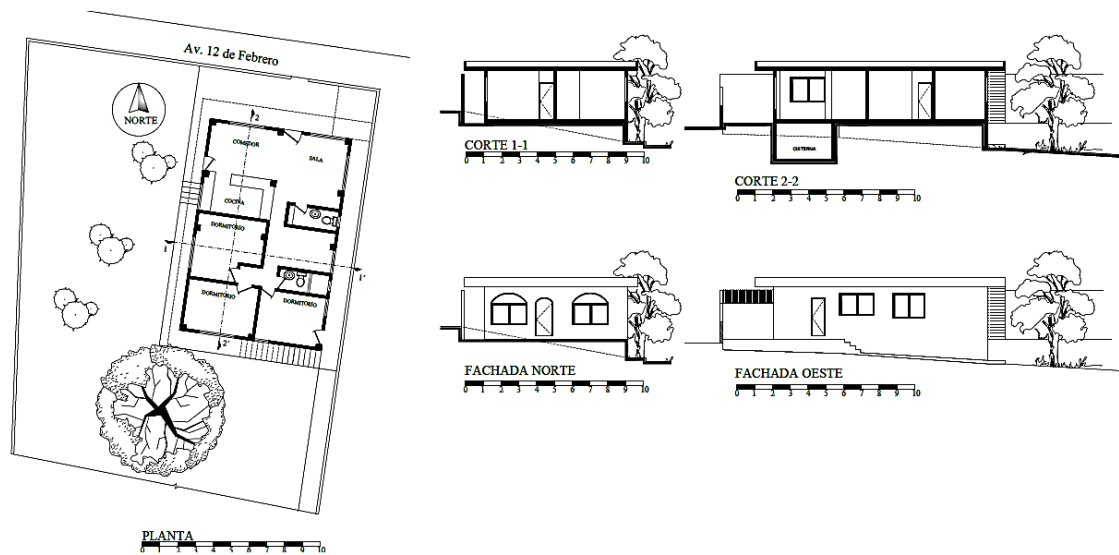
Plantas, cortes y fachadas vivienda 1. Elaboración propia 2017
